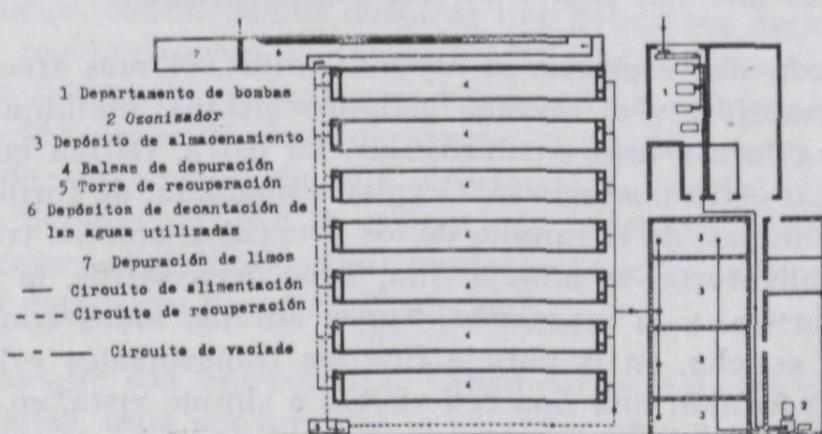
PLANTA DE UNA DEPURADORA POR OZONO
